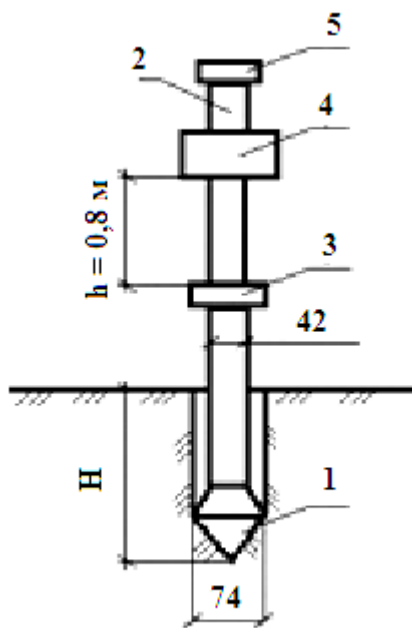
Схема установки для испытания грунтов динамическим зондированием:
